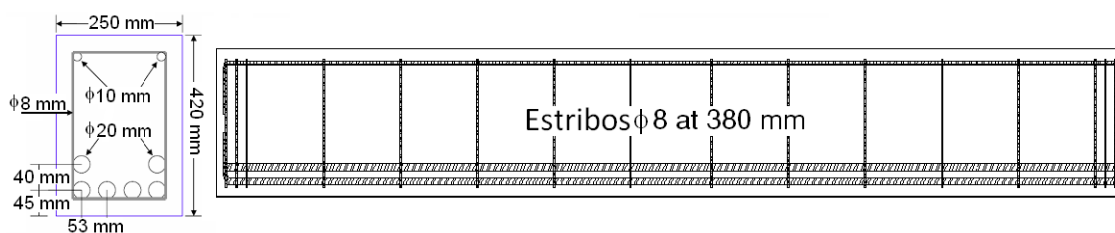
Esquema de refuerzo de las vigas de Alzate. (Alzate, 2012)
